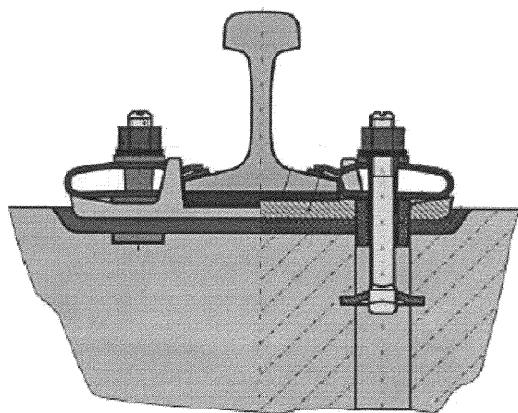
Упругое нераздельное рельсовое скрепление с пластинчатыми пружинными клеммами для железобетонных шпал (и подкладка, и клеммы закреплены к шпале с помощью анкерных болтов)
